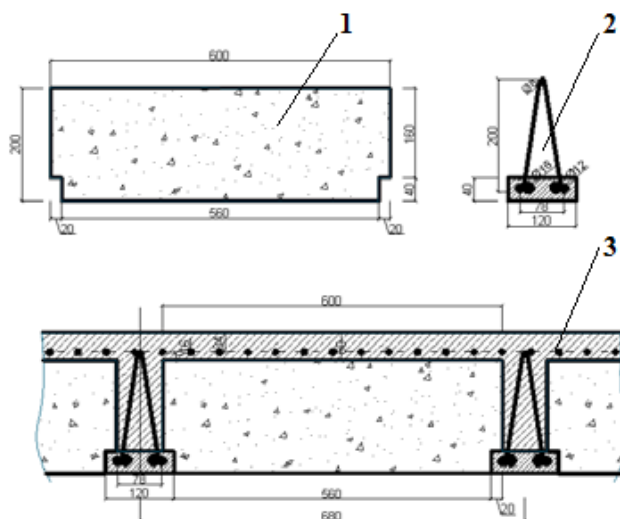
Элементы сборно-монолитного перекрытия YTONG: 1 – блок YTONG D500 размером 600x200x250 мм; 2 – балка YTONG; 3 – арматурная сетка
